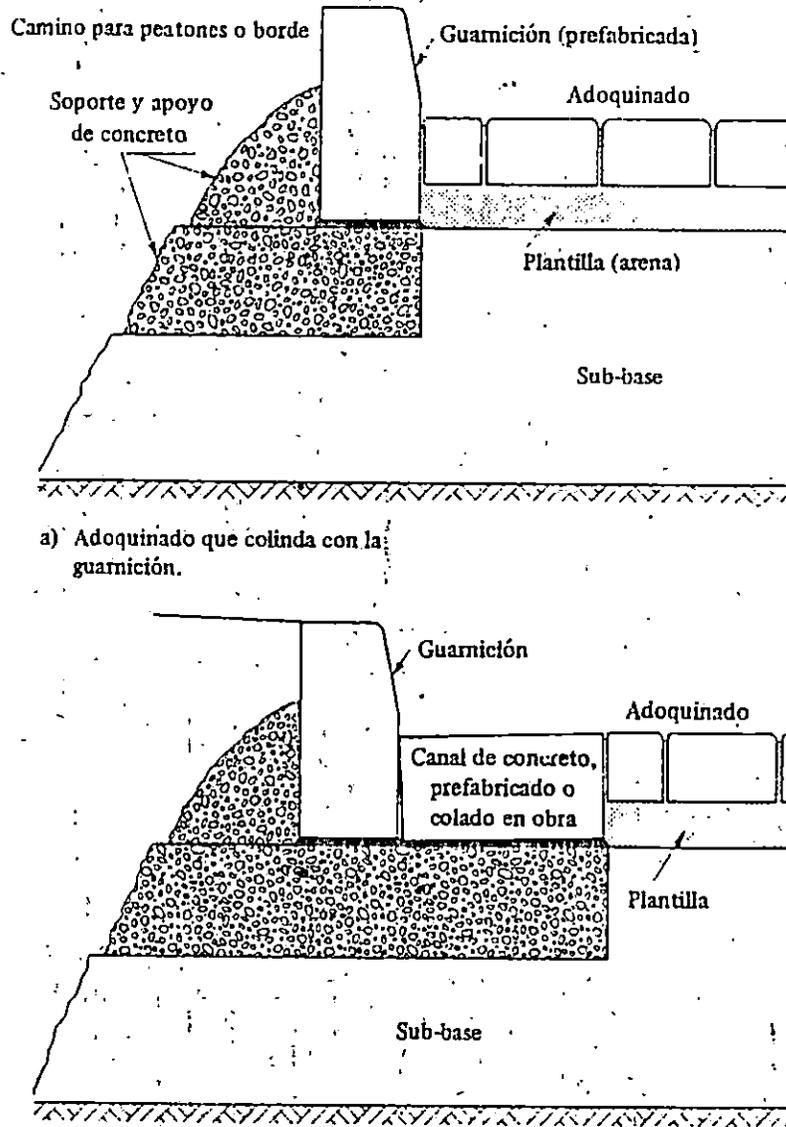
Detalles característicos de los diferentes elementos que constituyen un pavimento con adoquines.
